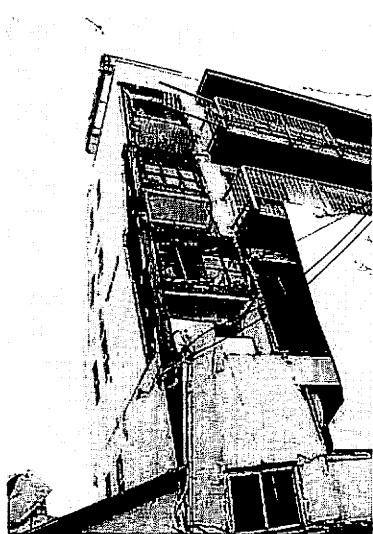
外壁が剥離、剥落したS造5階建て集合住宅
